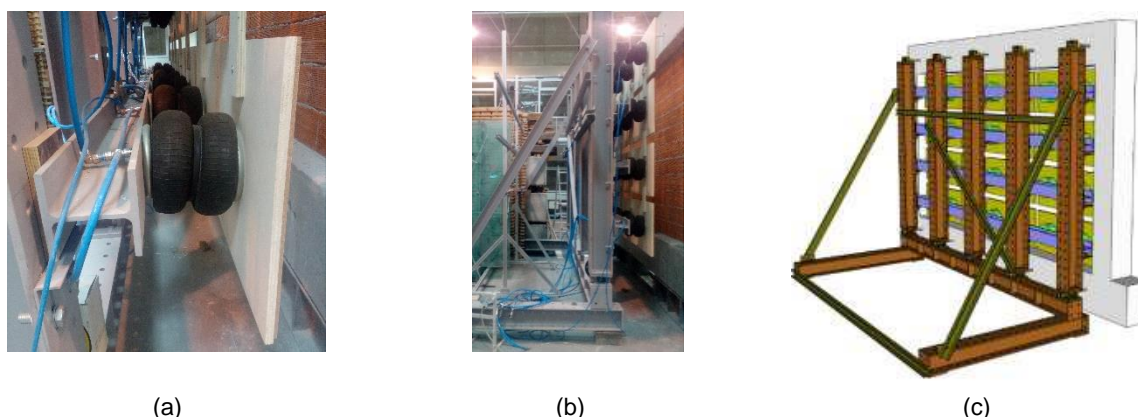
Estrutura metálica de reação, ligada ao pórtico de betão armado (a) Pormenor da ligação do atuador pneumático com o perfil horizontal (b) Vista lateral do sistema (c) Vista traseira do sistema (ilustração esquemática adaptada de [31])
